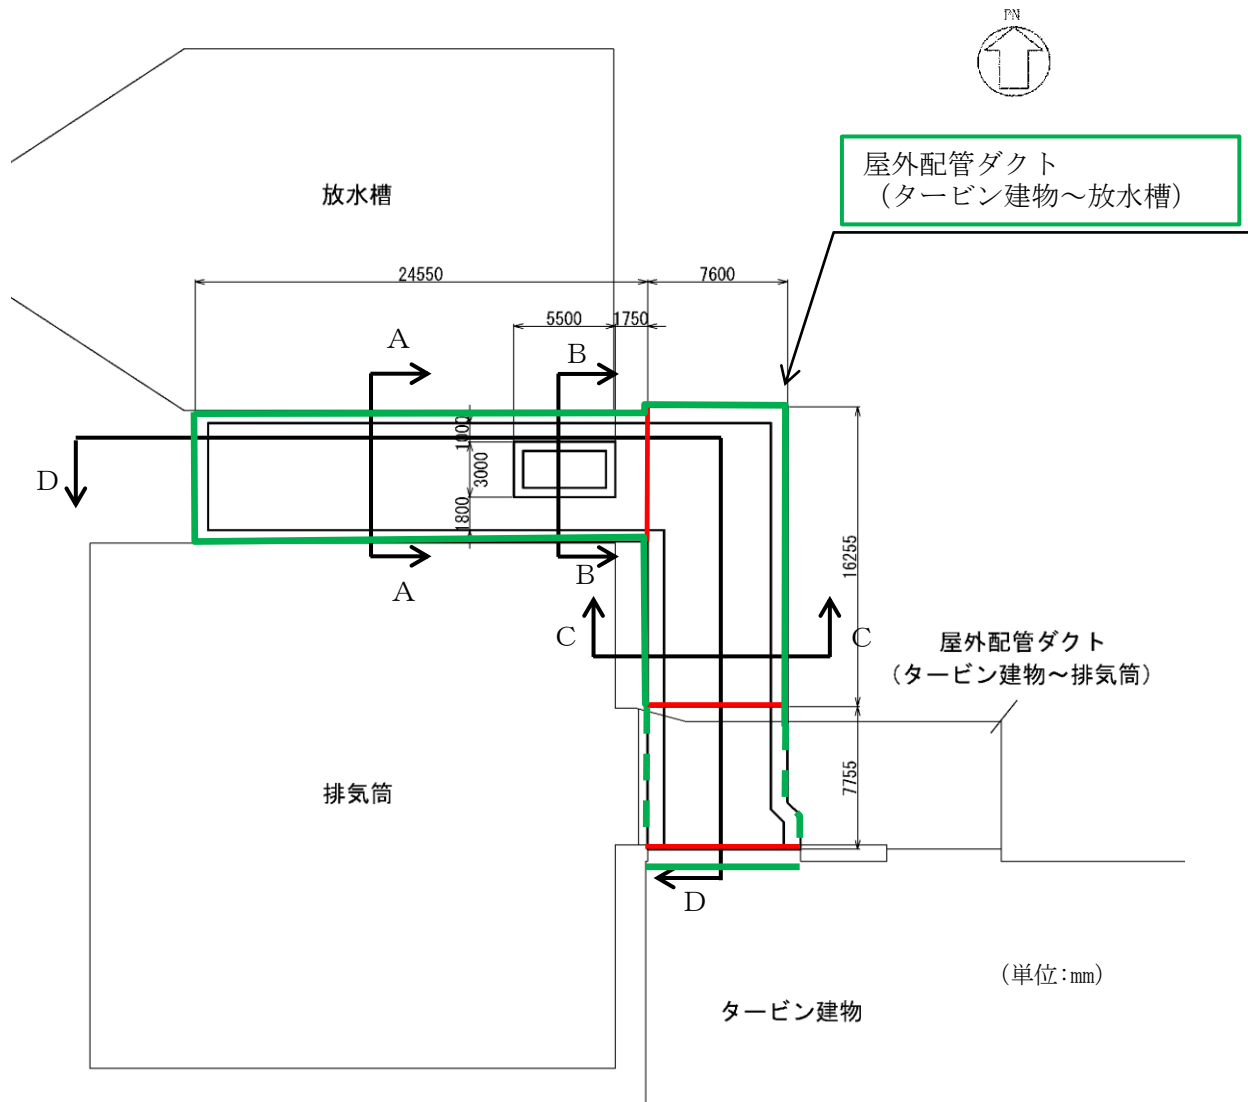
屋外配管ダクト（タービン建物～放水槽） 平面図
